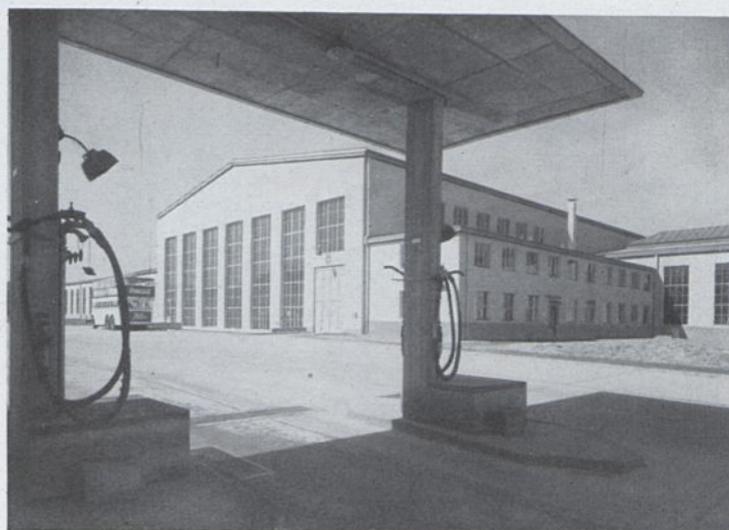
Halle II. Außenansicht. Im Vordergrund die Tankanlage.
